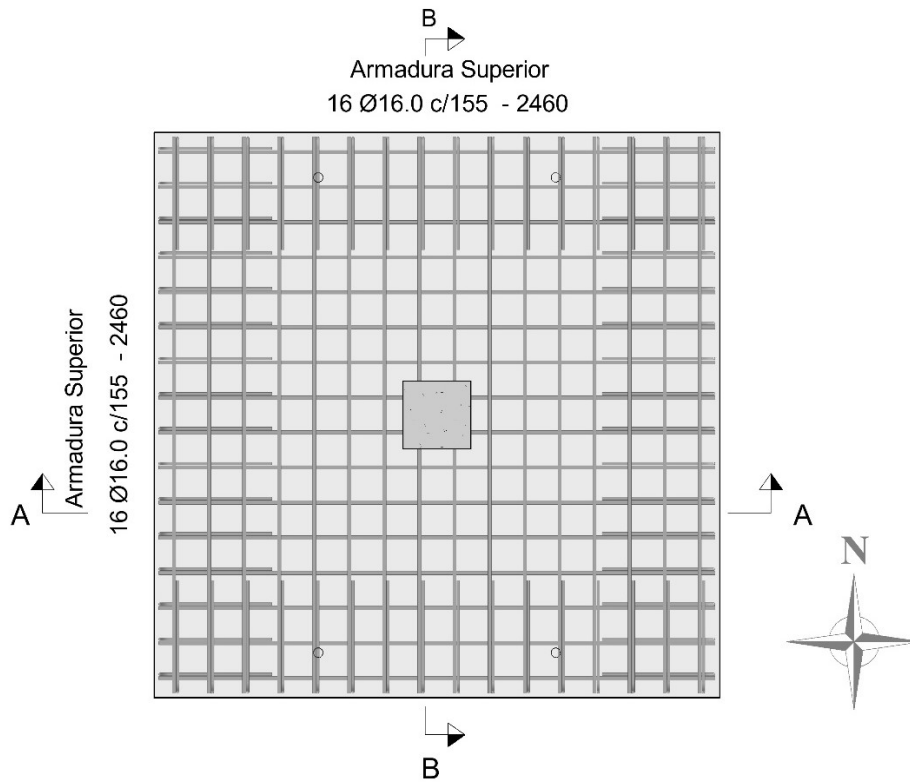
Detalhamento da armadura longitudinal superior.
